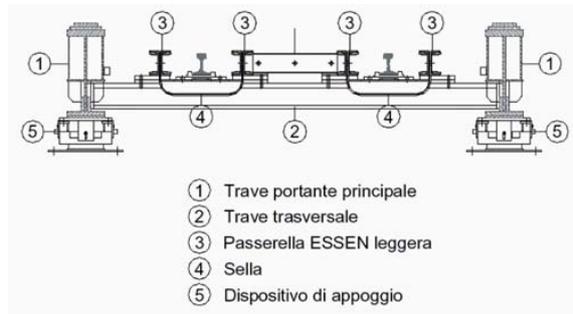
Sezione trasversale del Ponte "Essen Gemellato".
